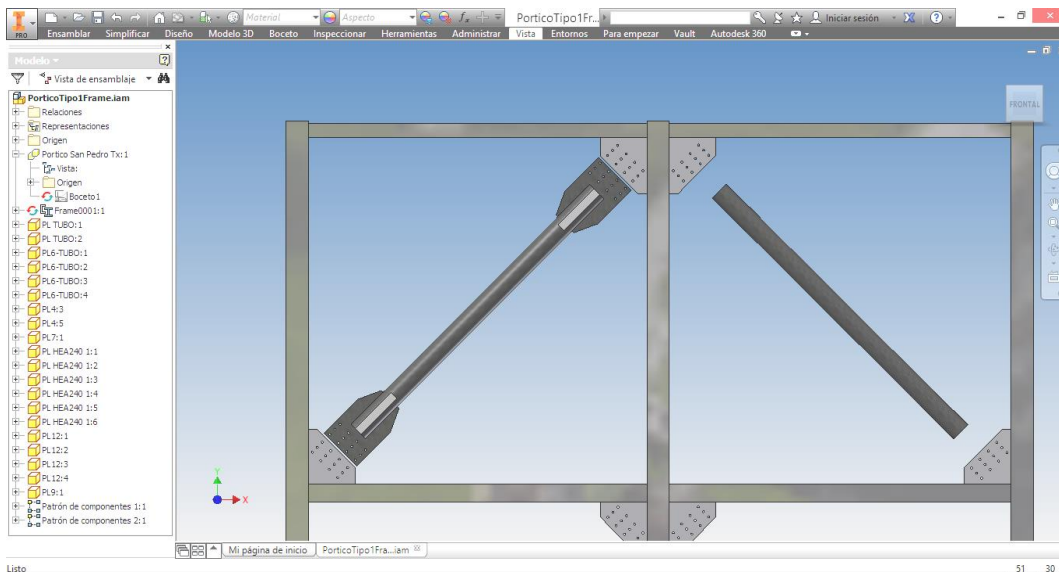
Diseño en Autodesk Inventor de pórticos para Refuerzo estructural Col. San Pedro4.
